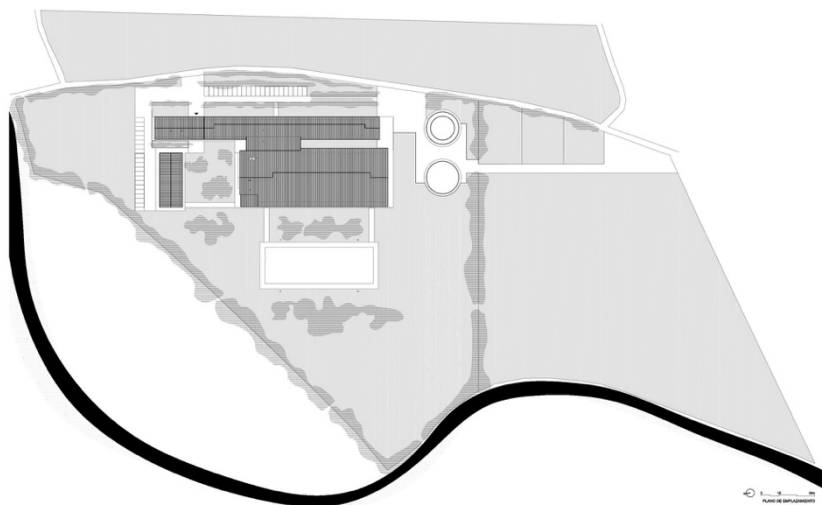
| Planta de implantação, geral | Navarra, Espanha | Francisco Mangado | 2008
